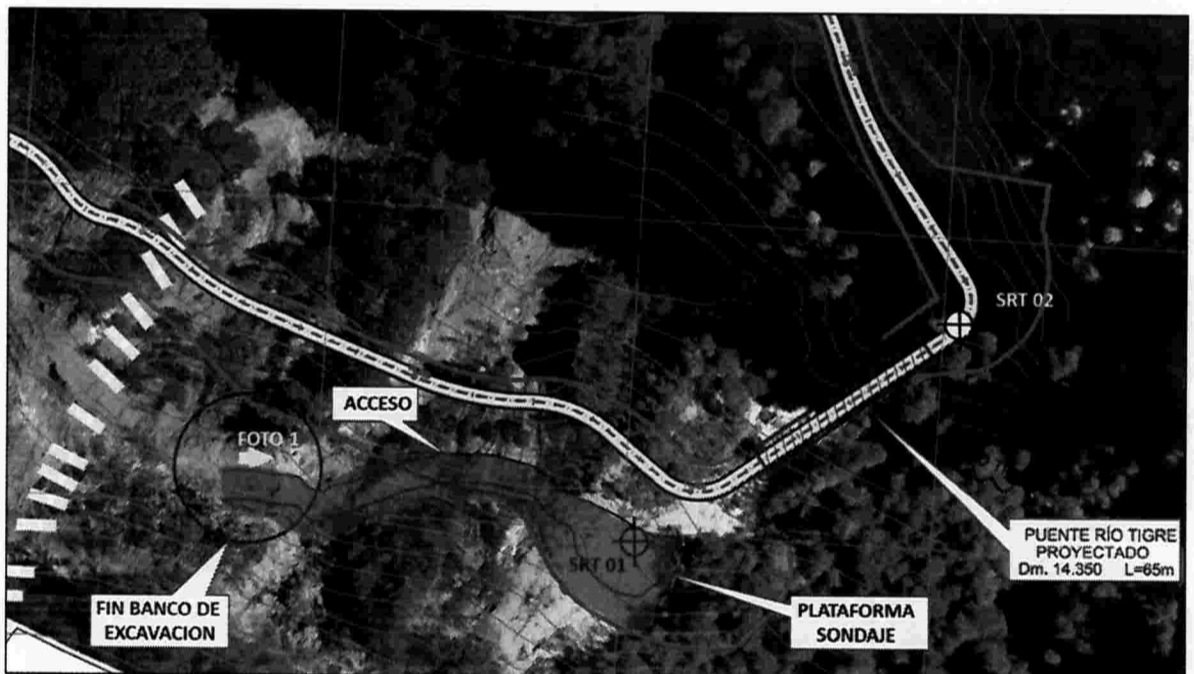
Planta Excavación a plataforma sondaje SRT 01 y ubicación de sondaje SRT 02.
